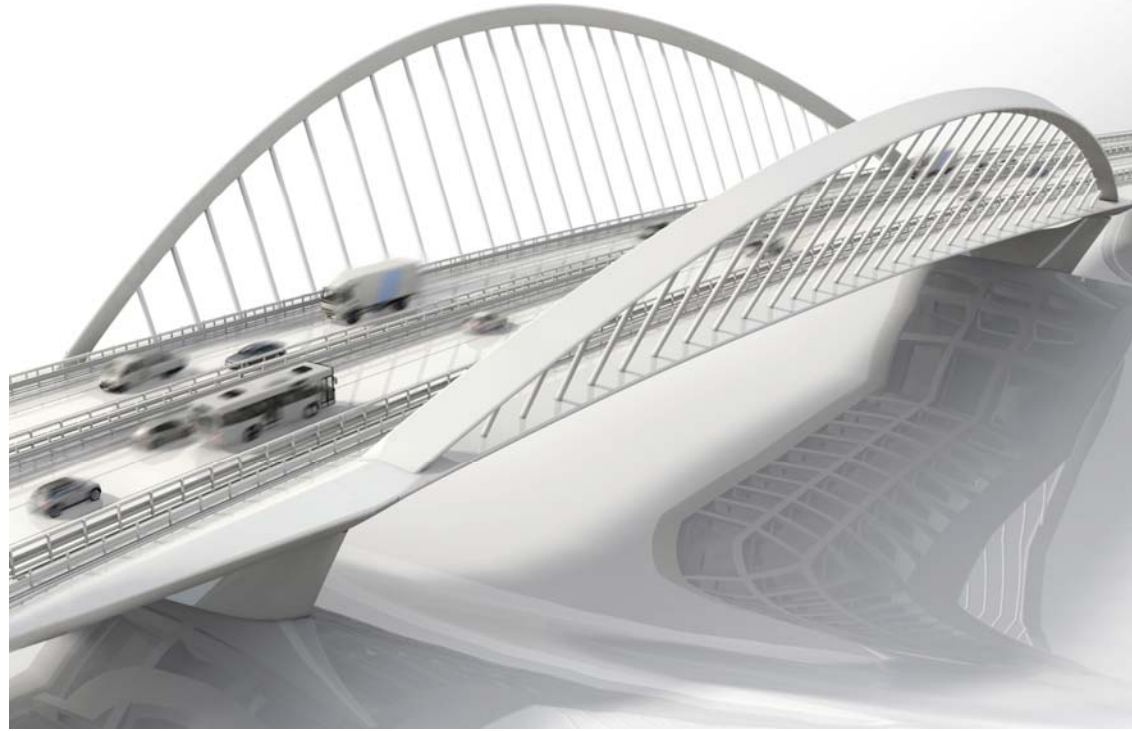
Immagine della soluzione ad arco (spalle alla A22)
